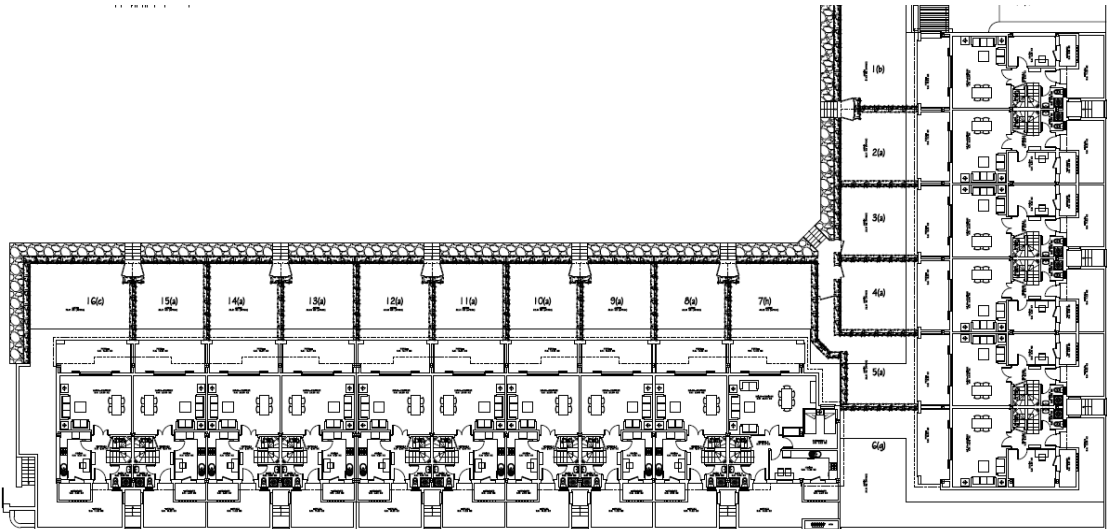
Planta baja del Bloque 1 de la Manzana R1. Huerta de Enmedio
